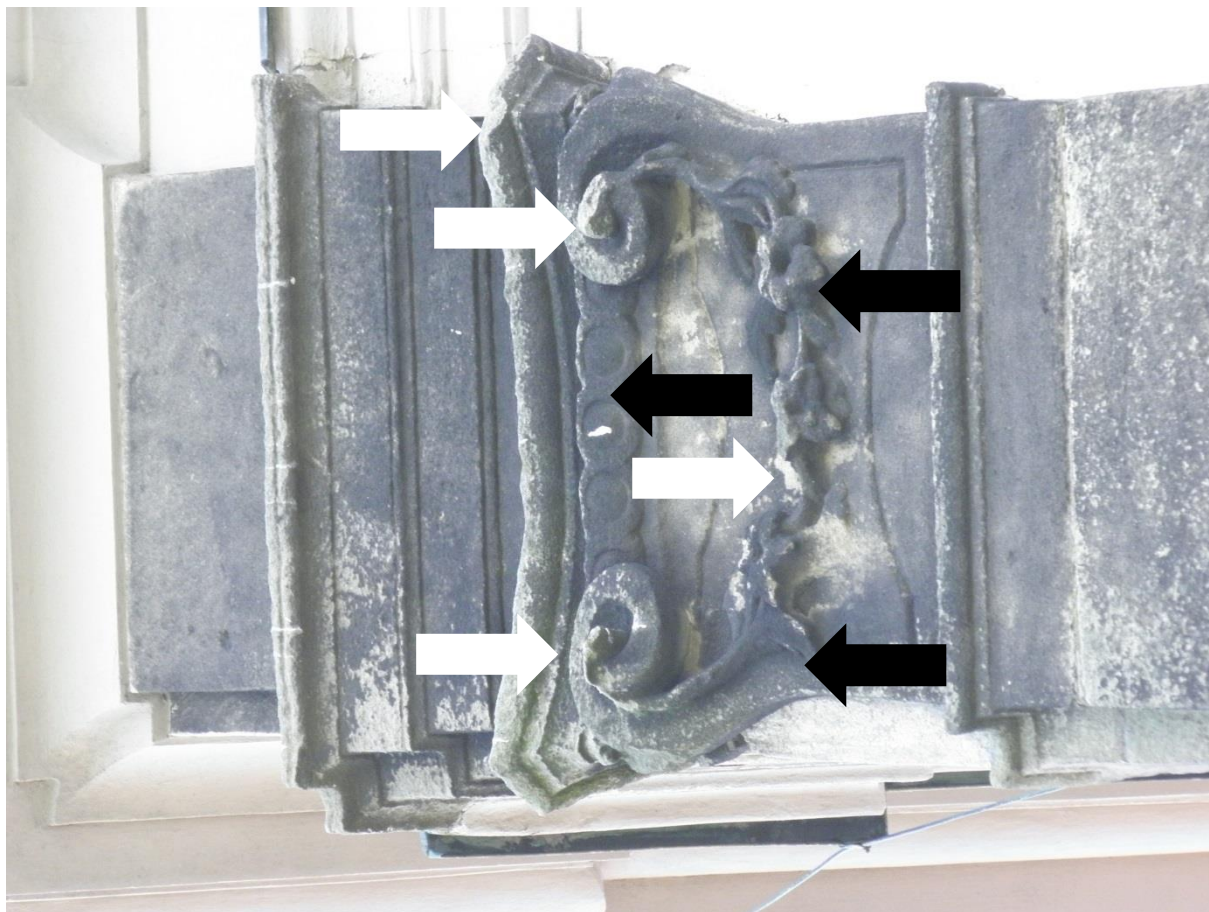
/ Pilastr atiky vpravo od erbu – detail. Eroze povrchu.
